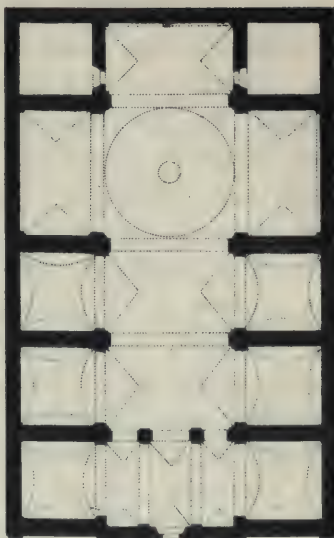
Valencia. Ehemalige Kollegskirche. Grundriß.
